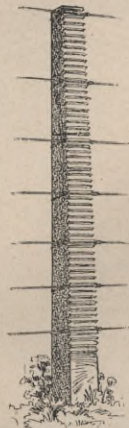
Betonpfeiler mit Einkerben zum Einlegen von Zaundrähten.
